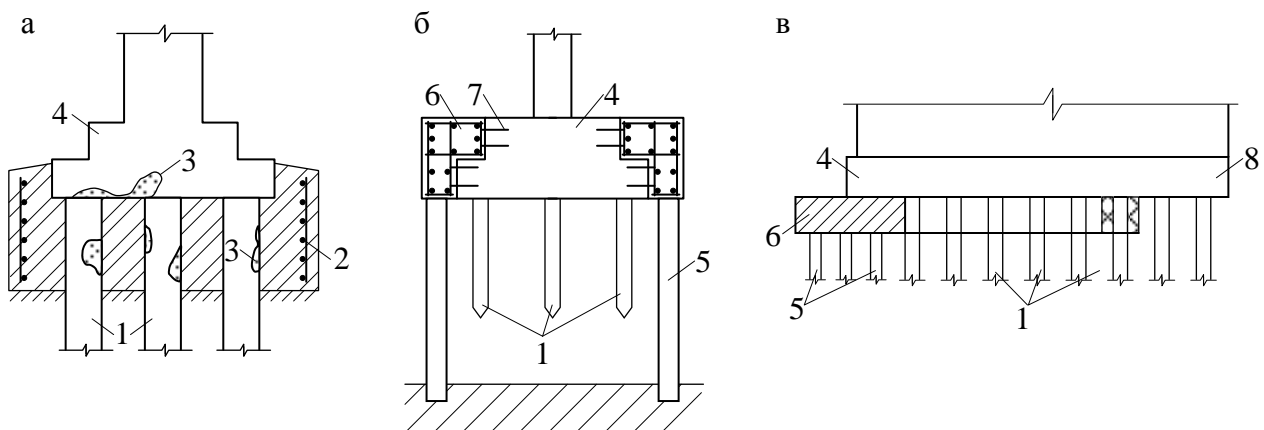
Підсилення пальових фундаментів: а – омонолічуванням оголовок паль; б – влаштуванням виносних паль; в – підведенням додаткових паль; 1 – існуючі палі; 2 – залізобетонна обойма; 3 – пошкодження у палі та ростверку; 4 – ростверк; 5 – додаткова виносна паля; 6 – новий ростверк; 7 – зв'язки додаткового ростверку з тим, що підсилюється; 8 – сторона будівлі, по якій вирубувались палі
